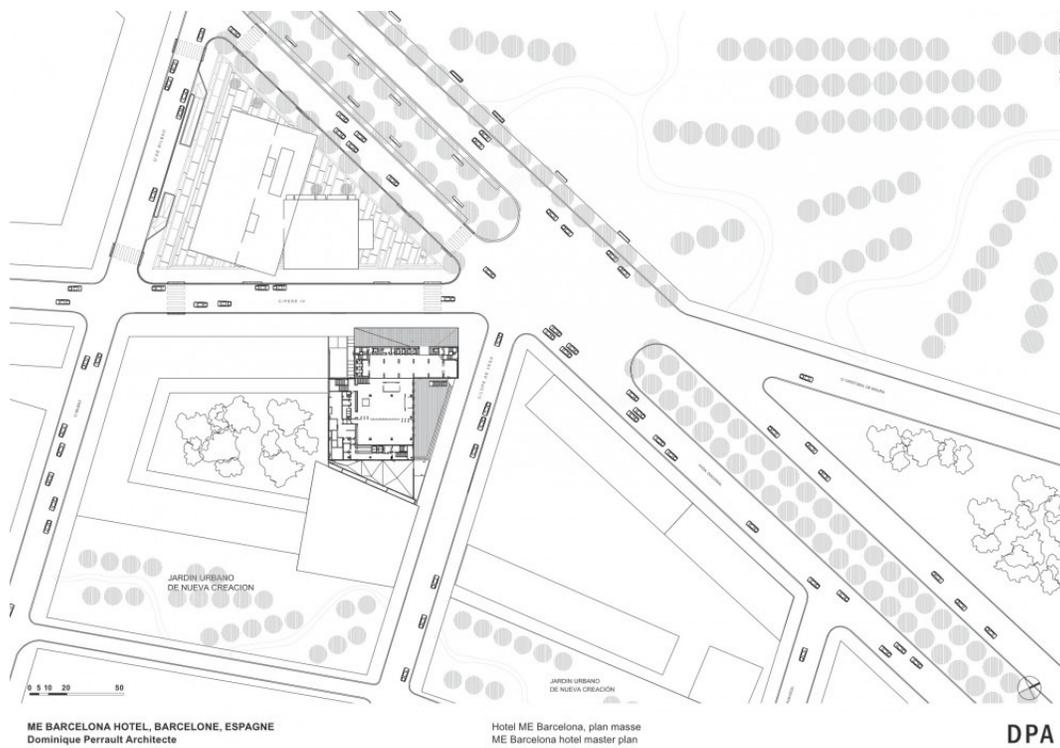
HOTEL ME BARCELONA – IMPLANTAÇÃO
